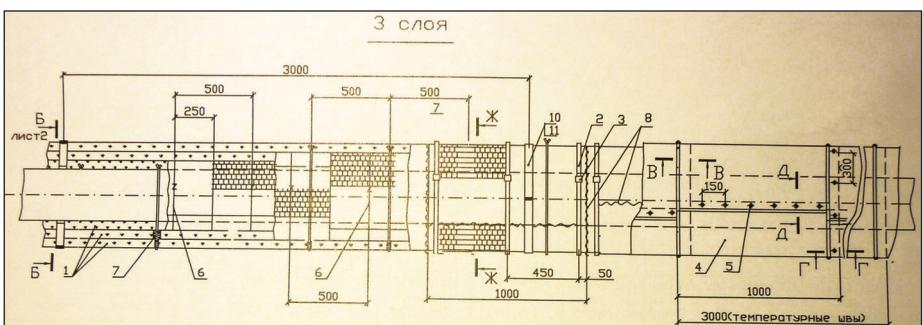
Тепловая изоляция трубопроводов матами минераловатными прошивными в обкладках в три слоя
